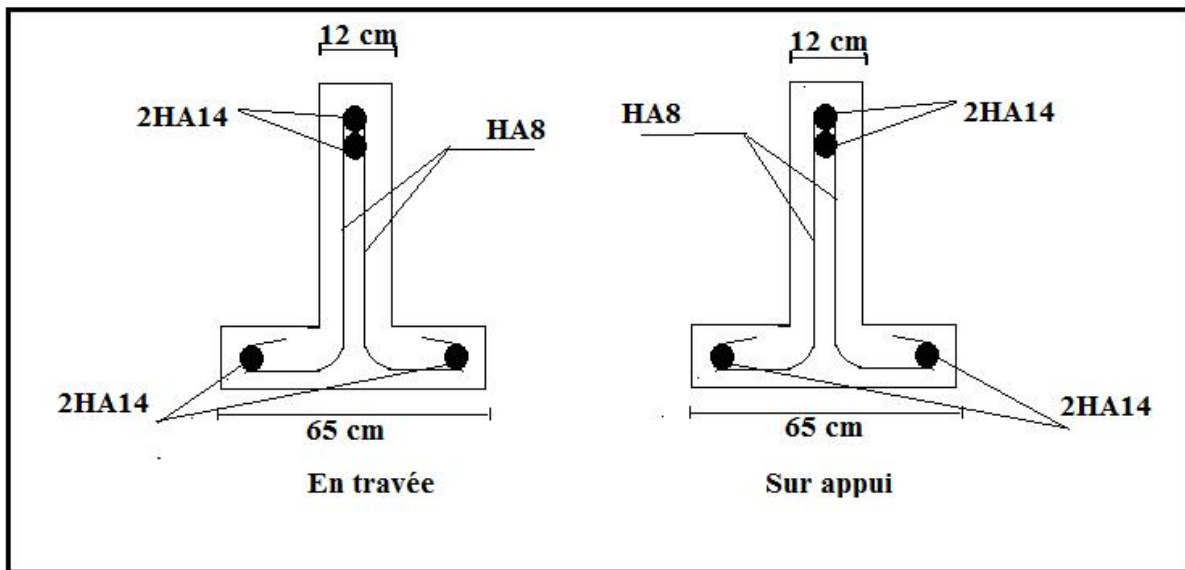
Disposition constructive des armatures des poutrelles (Plancher terrasse).
